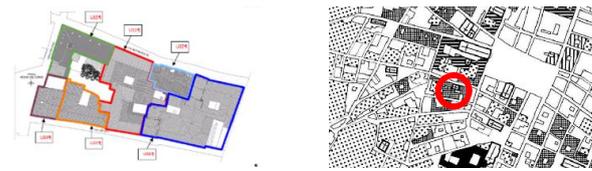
a) Individuazione delle US dell'aggregato, b) planimetria storica del Vandi
